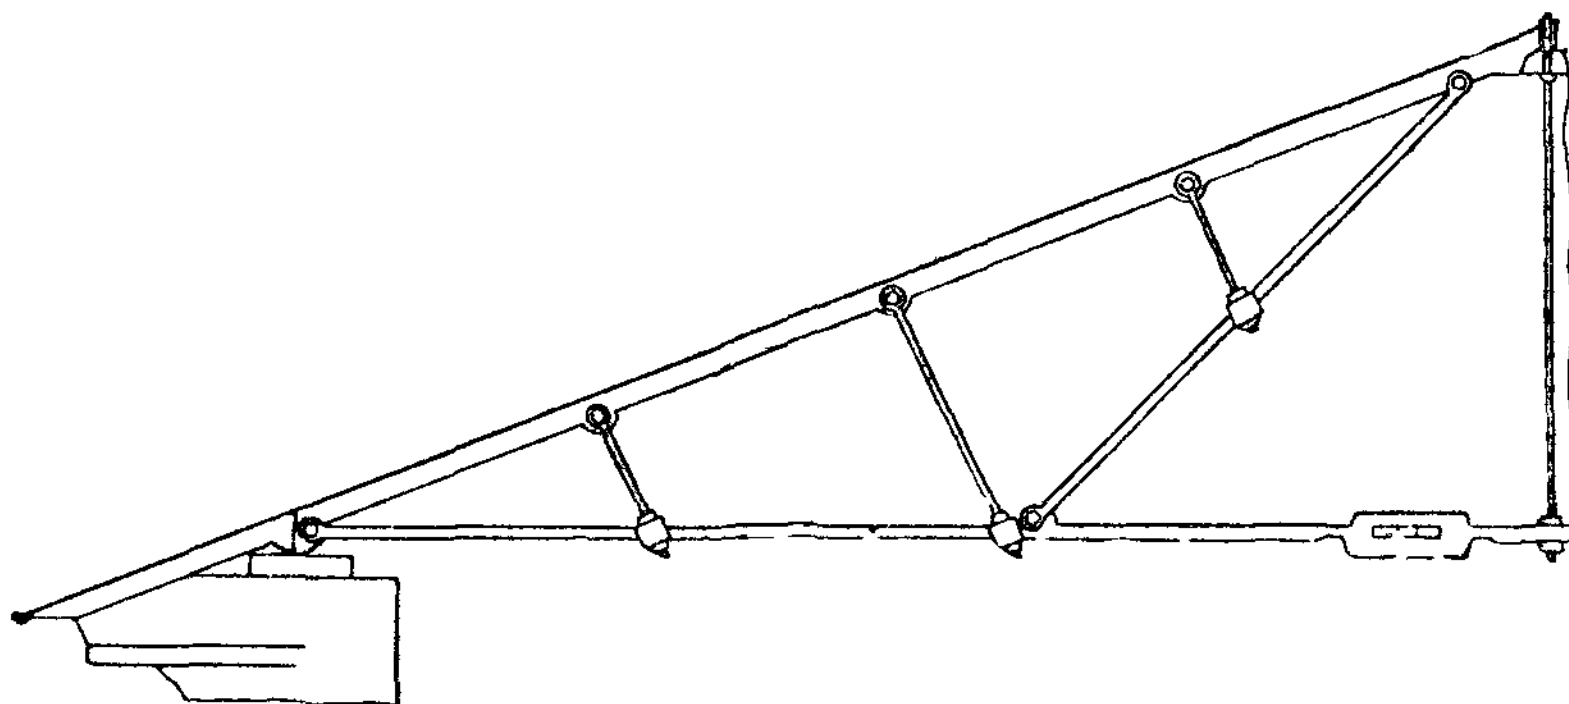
Перекрытие Зимнего дворца в Петербурге (1837 г.)
